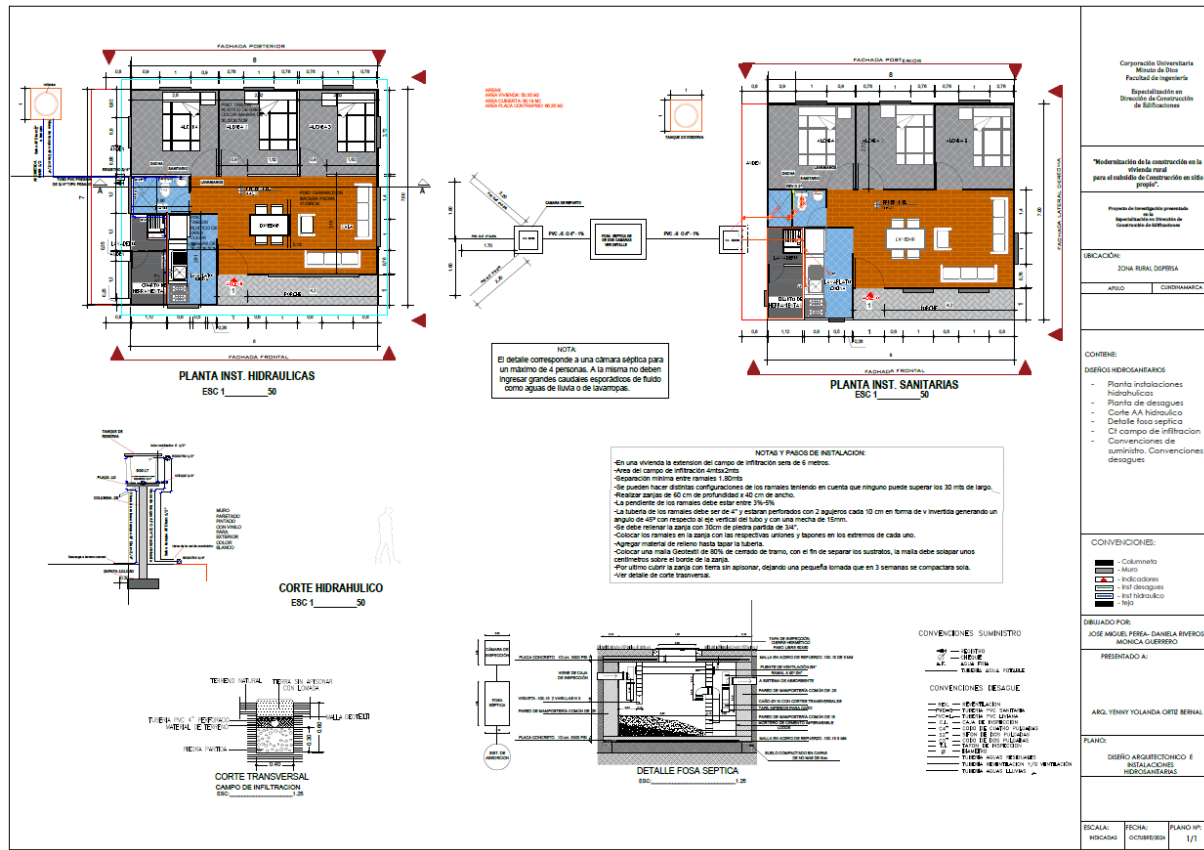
Plano diseño arquitectónico e instalaciones hidrosanitarias. Fuente: Autores, 2024.
